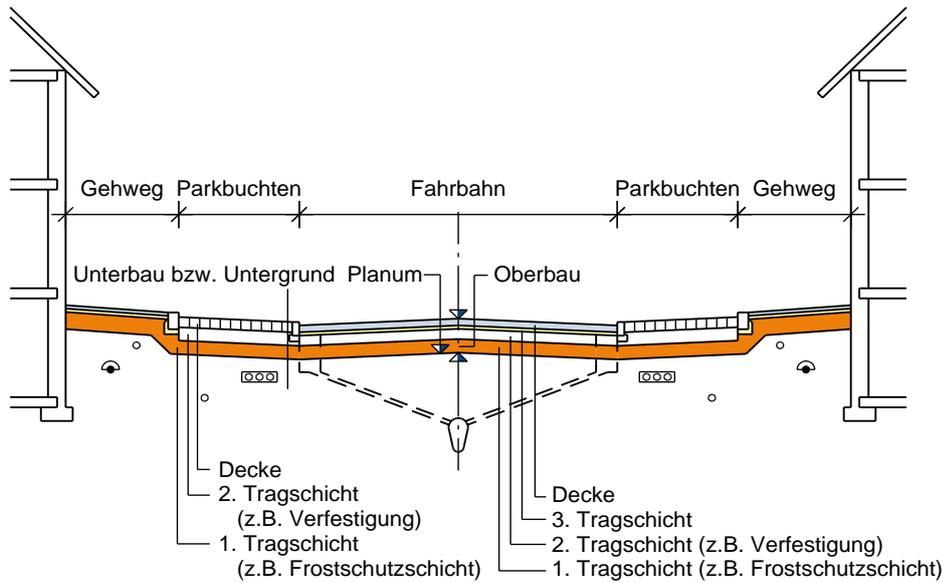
In geschlossener Ortslage mit wasserundurchlässigen Randbereichen und geschlossener seitlicher Bebauung sowie mit Entwässerungseinrichtungen
